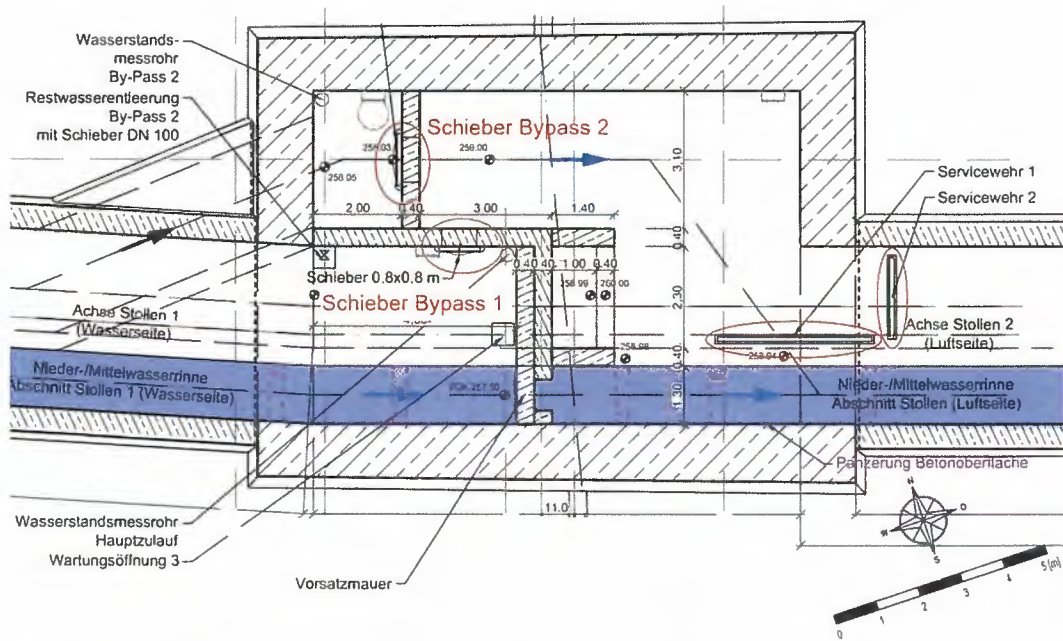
Horizontalschnitt durch das Kontrollbauwerk (aus Beilage 12.5.3)
